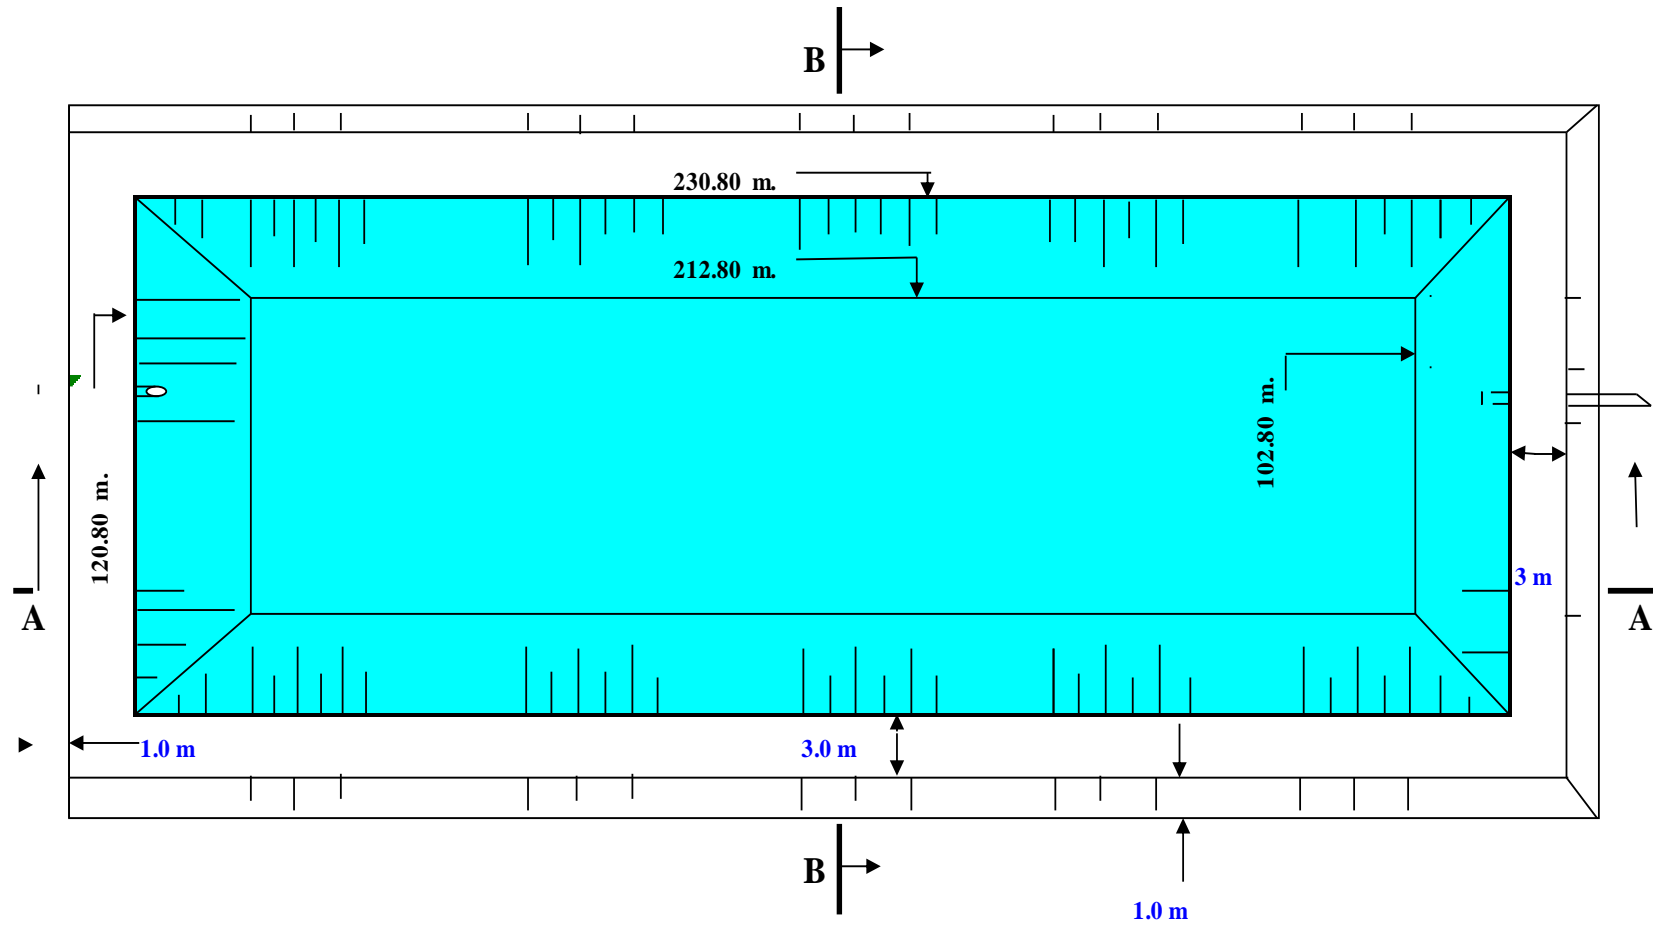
Dimensiones laguna secundaria – Detalle en Planta
